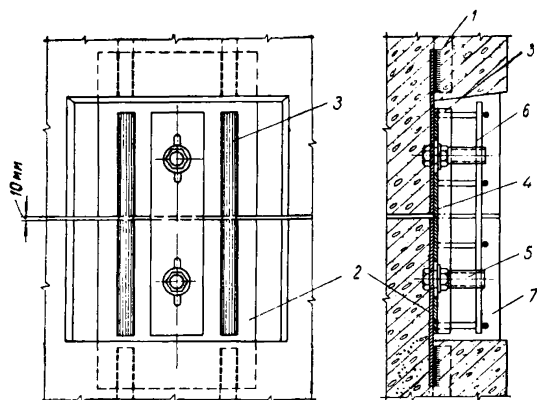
Деталь стыка продольной арматуры труб из сборных железобетонных цагр
